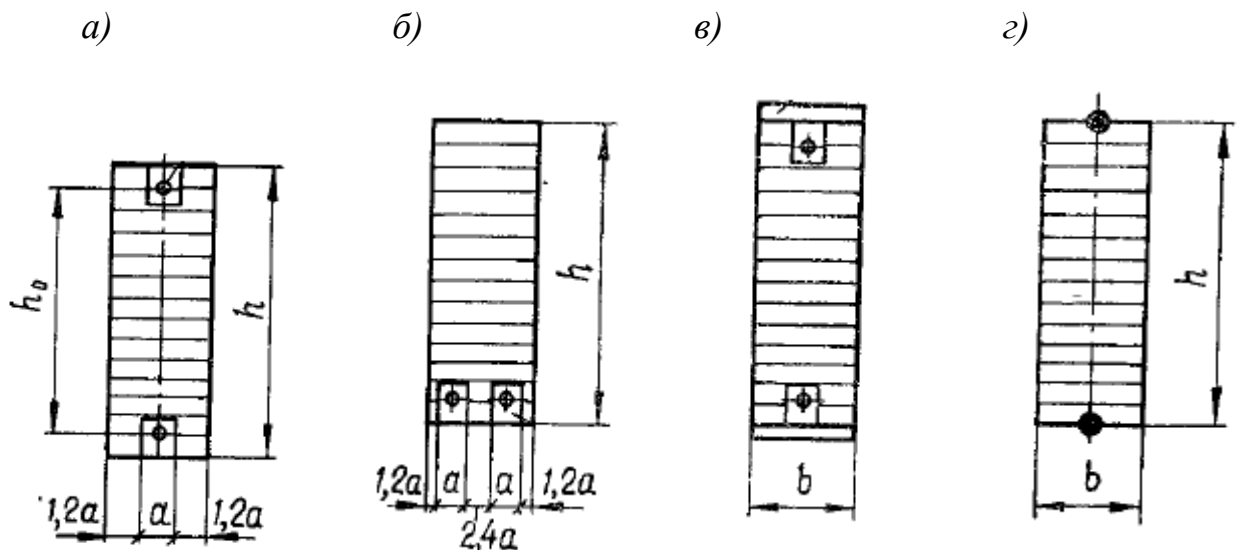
Армування балок з клеєної деревини: а – переріз симетричного армування; б – переріз несиметричного армування; в – балка з захисними накладками; г – розміщення арматури для розрахунку балок.
